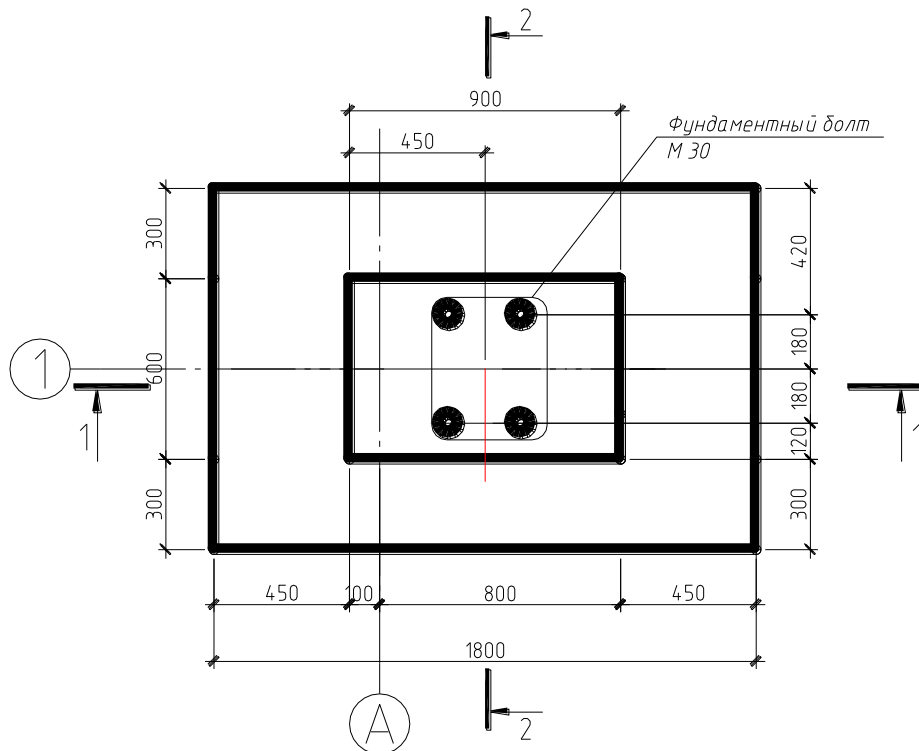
Схема к расчету арматуры плитной части фундамента
